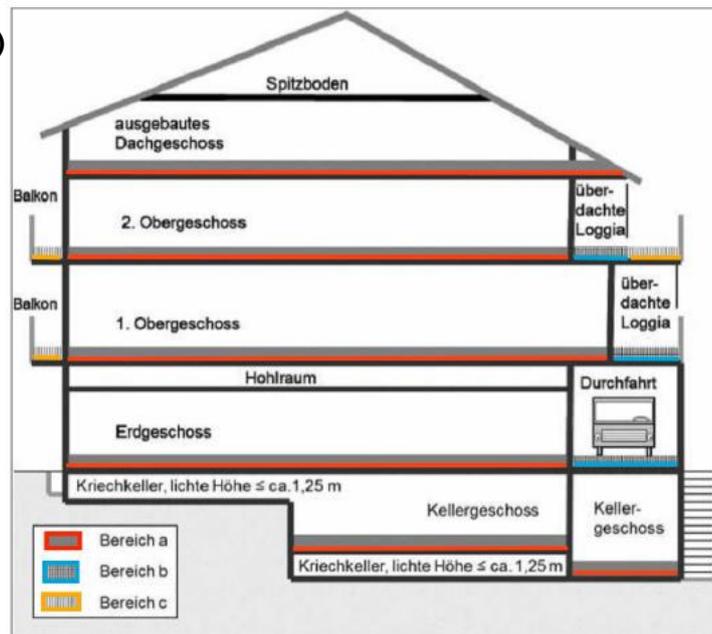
Brutto-Grundfläche nach der Sachwertrichtlinie
